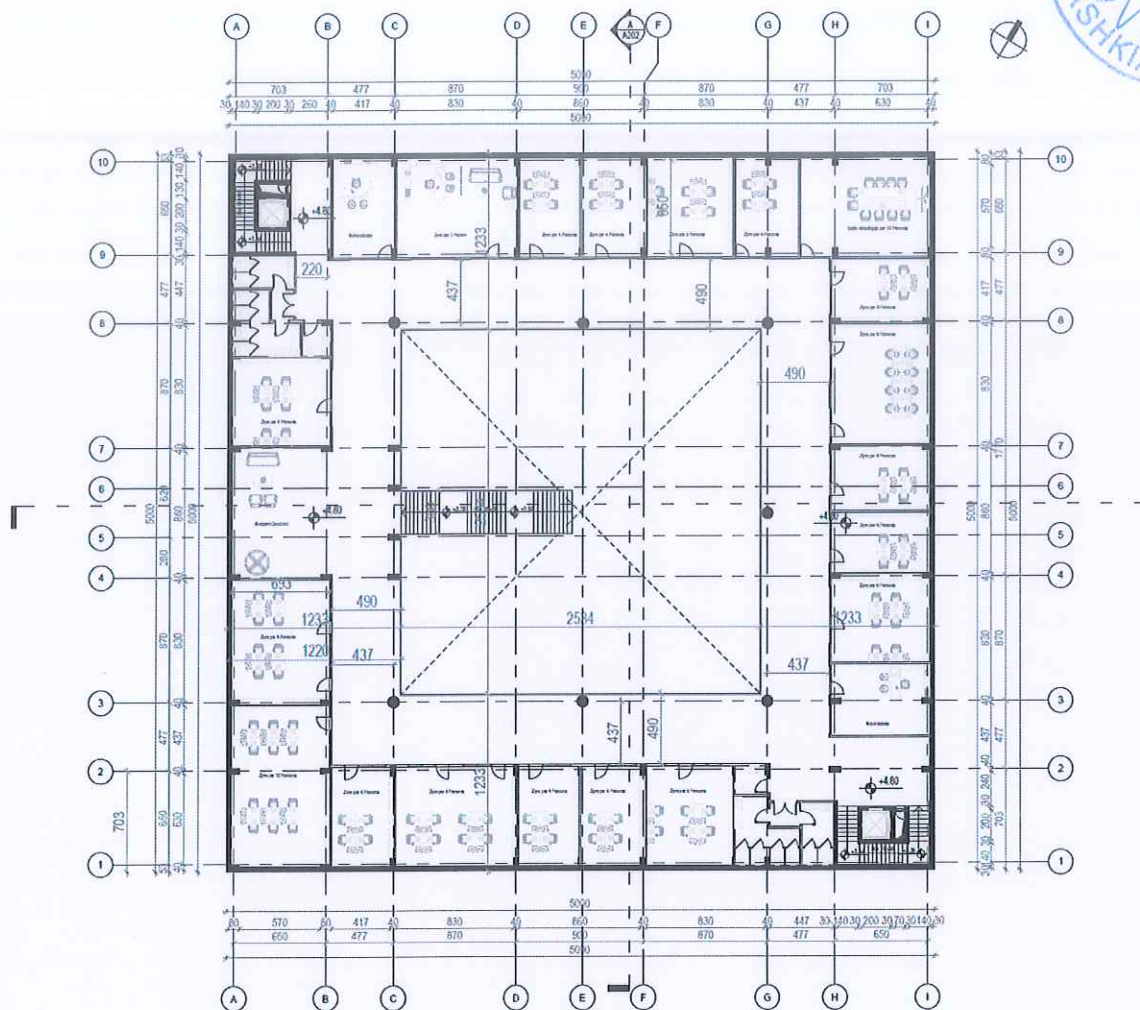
Planimetri “Qendër Biznesi” – Kati 1
